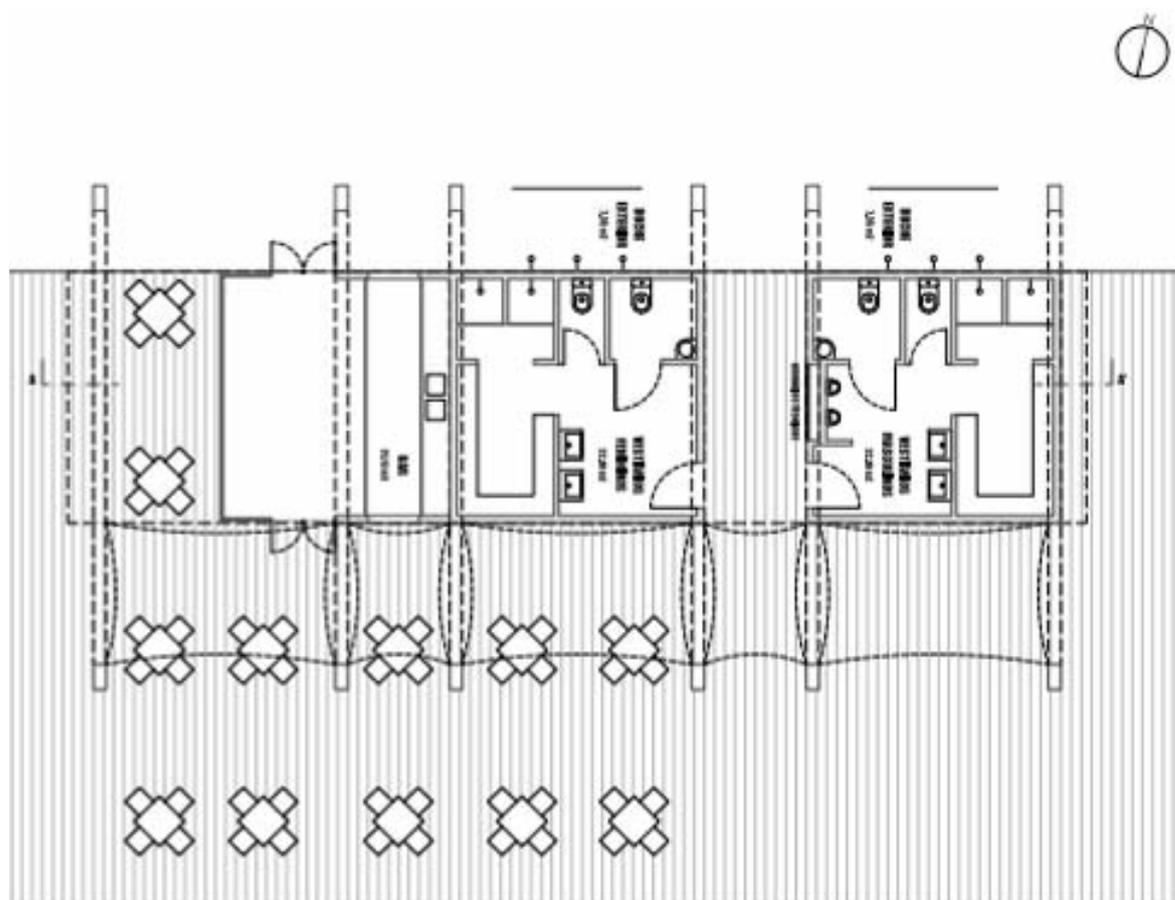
PARQUE DESPORTIVO – IMPLANTAÇÃO DOS BALNEÁRIOS
